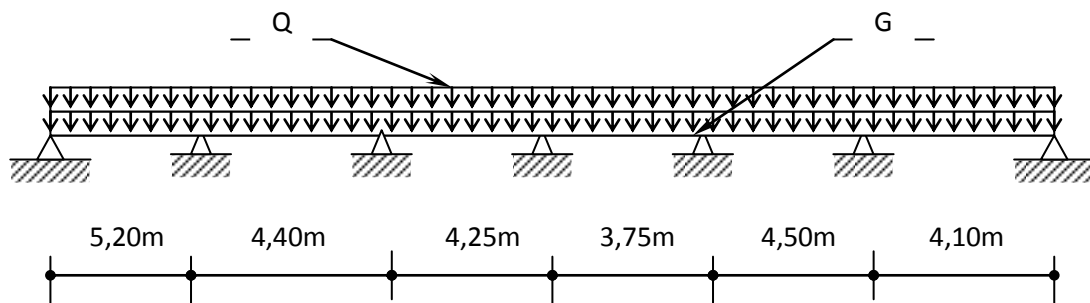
Schéma statique de la poutrelle à six (06) travées.
